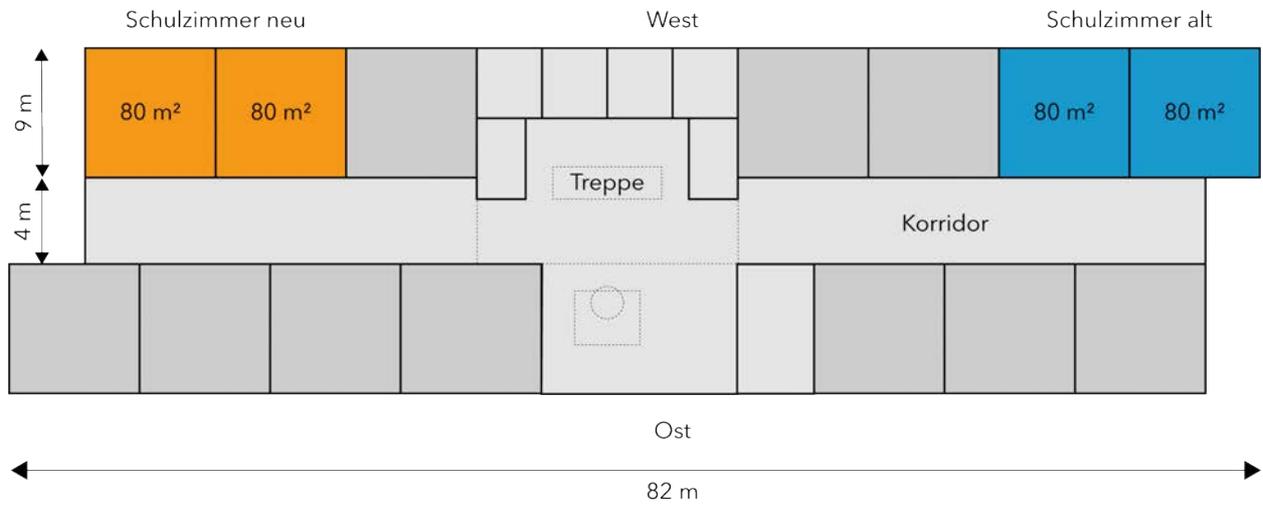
Grundriss Schulhaus 2. Obergeschoss (orange: neue Beleuchtung, blau: alte Beleuchtung)
